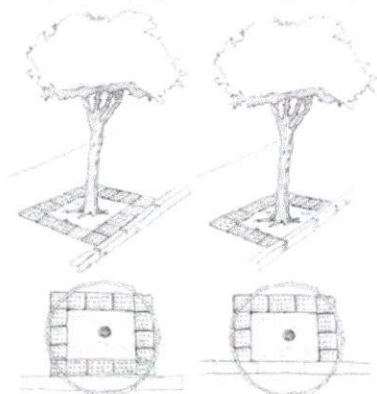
Indicação do alegrete com piso tátil em calçadas
